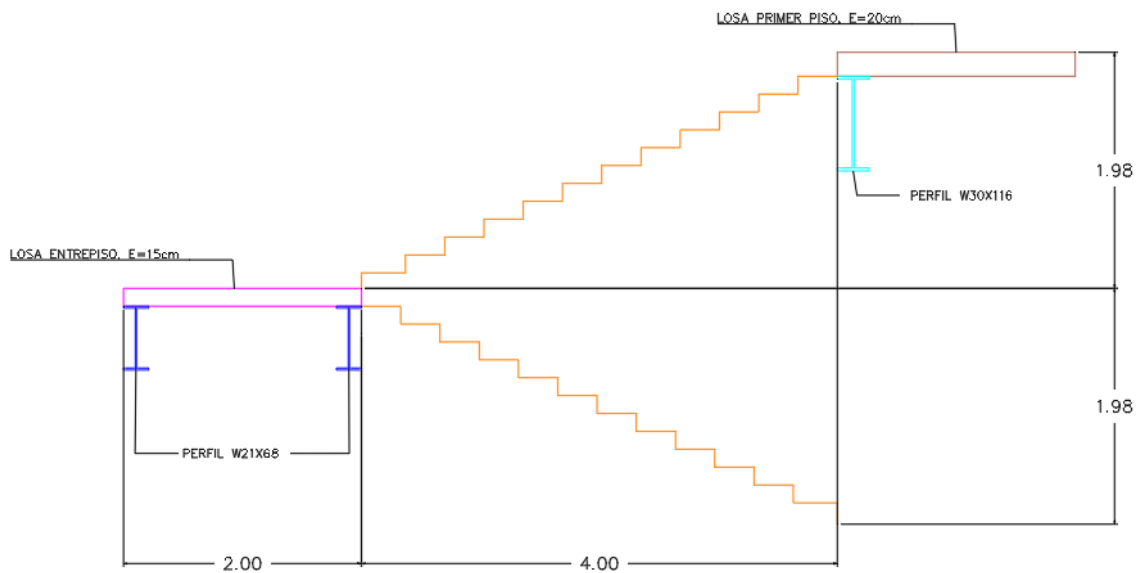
Vista lateral de las escaleras de la edificación desde el segundo hasta el octavo piso.
